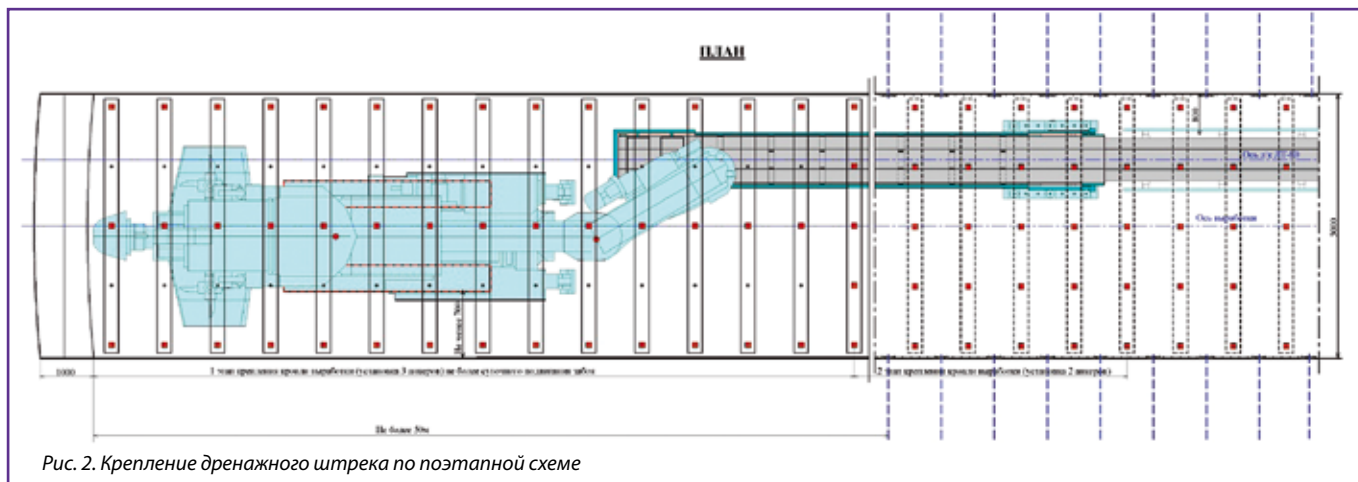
Крепление дренажного штрека по поэтапной схеме
